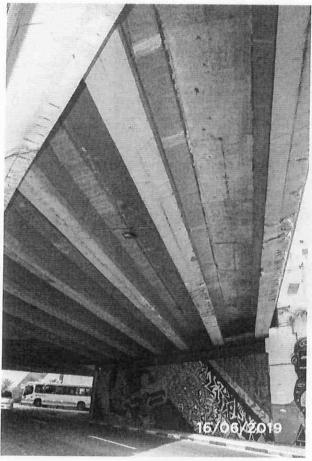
Vista da face inferior do tabuleiro, sentido rodovia. Vigas com desplacamento de concreto, infiltrações, armaduras expostas.
